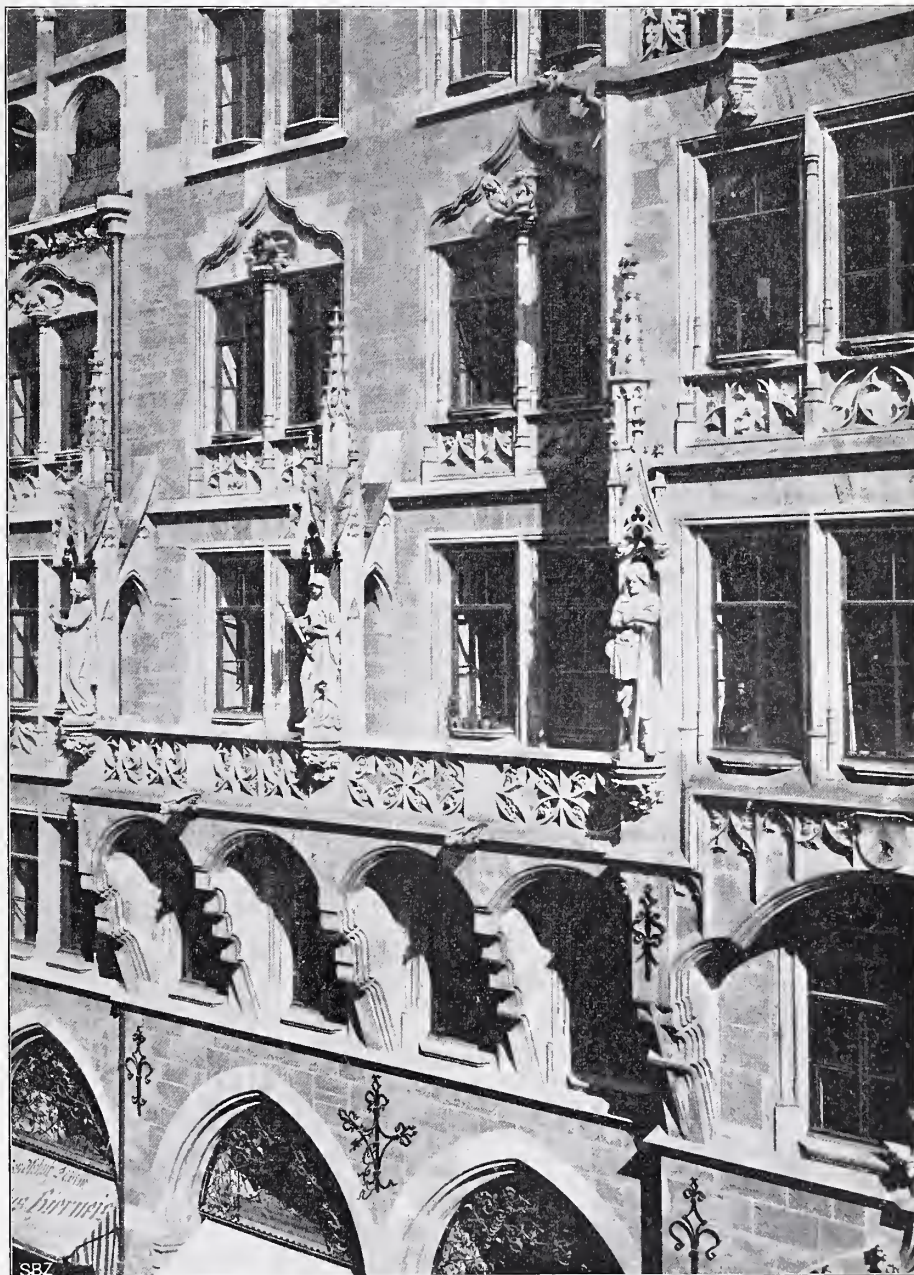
Ausschnitt aus dem Mittelteil der Weinstrassen-Fassade.
